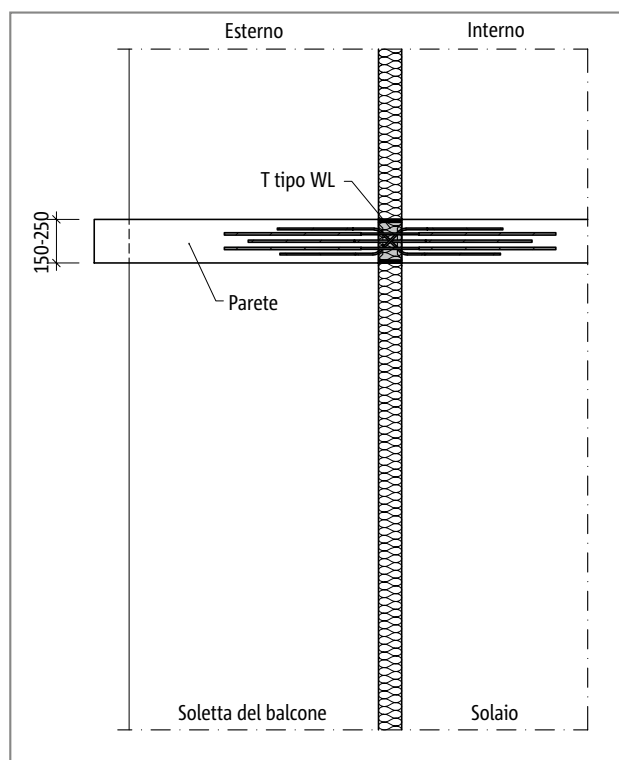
Schöck Isokorb® T tipo WL-M1-V1: pianta del prodotto
